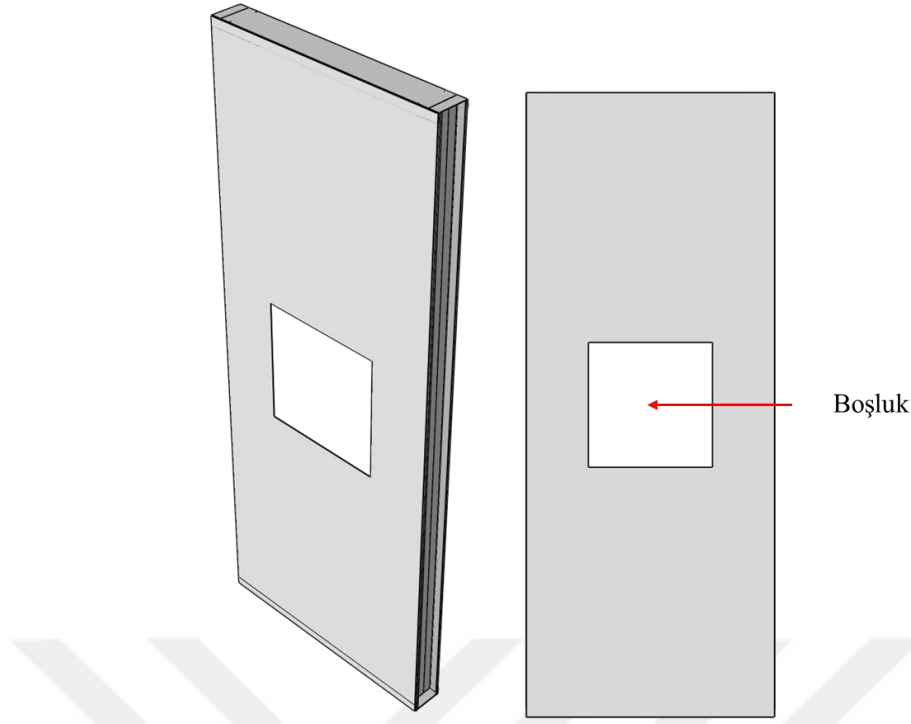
Numunelerde kullanılan berkitme desenleri (devamı)
